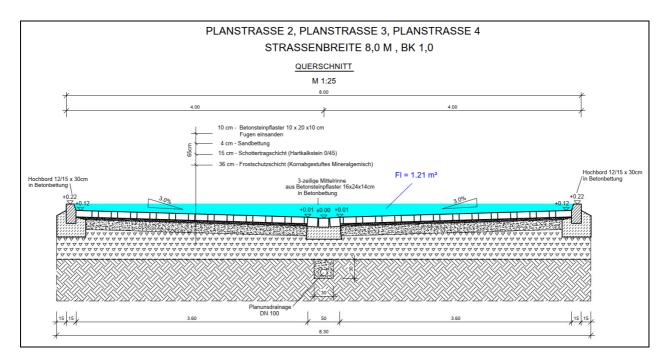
Straßenplanung Baugebiet "Wohnquartier am Bellingholz", Querschnitte Planstraßen, DW- Ingenieure GmbH, unmassstäblich
